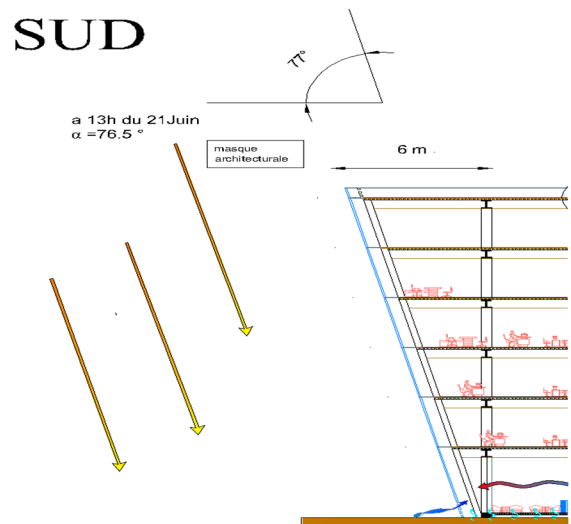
zoom sur le masque architectural coupe A-A. Source : auteurs
